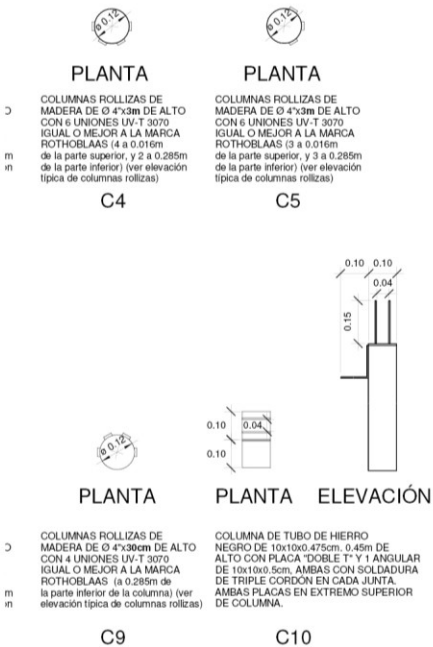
Lámina 08, planimetría de tipología A.<sup>307</sup>
